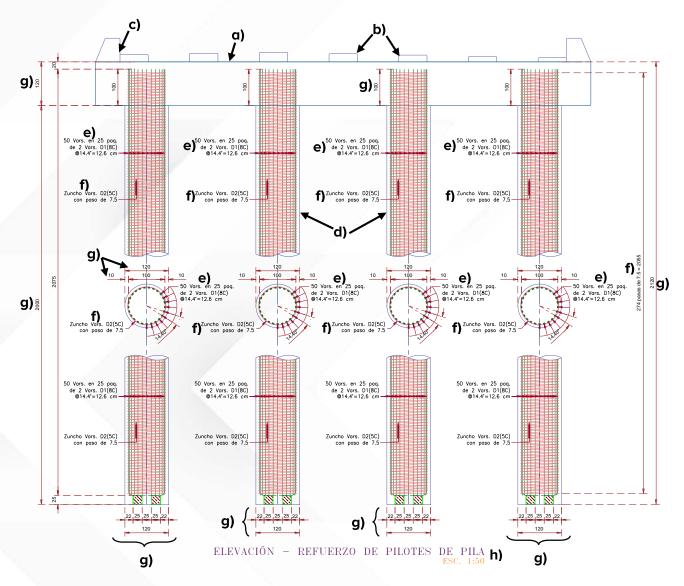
Ejemplo de elevación del refuerzo de pilotes de pila
